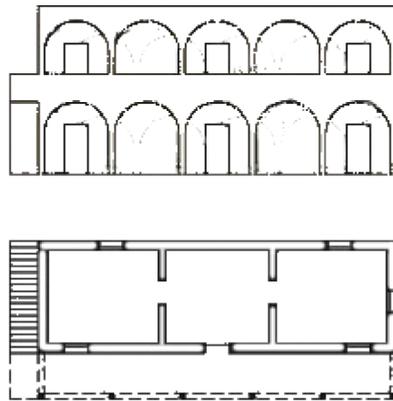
Das Haus mit dem "Riwaq"- Grundriss, Ansicht & Bild
